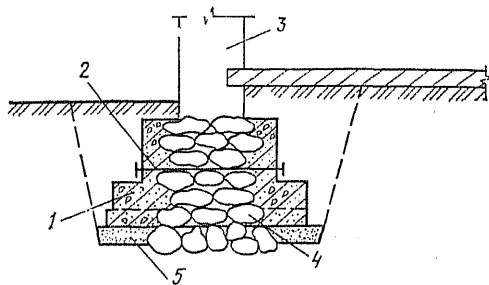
Увеличение площади подошвы бутового фундамента
